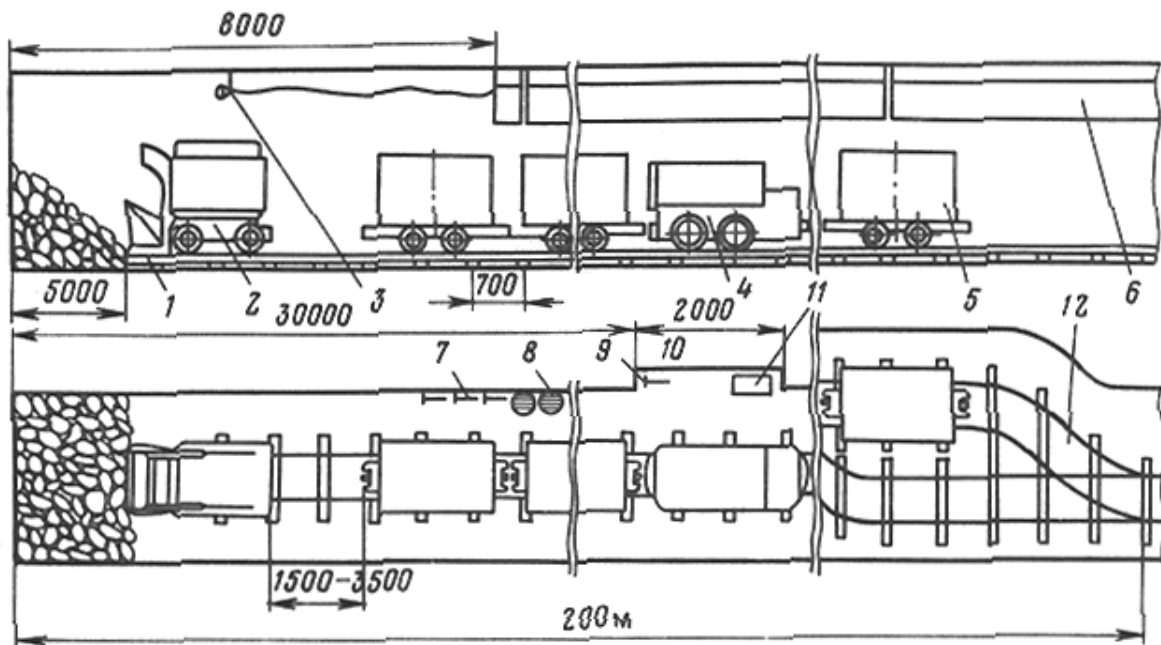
Схема расположения оборудования в забое штольни: 1 – рельсовый путь; 2 – погрузочная машина ППН-1; 3 – переносной светильник; 4 – электровоз 4,5 АРП-2М; 5 – вагонетка; 6 – вентиляционные трубы диаметром 500 мм; 7 – перфораторы; 8 – водяные и воздушные шланги; 9 – ниша для инструментов; 10 – запасной перфоратор; 11 – ящик для инструмента; 12 – разминка
